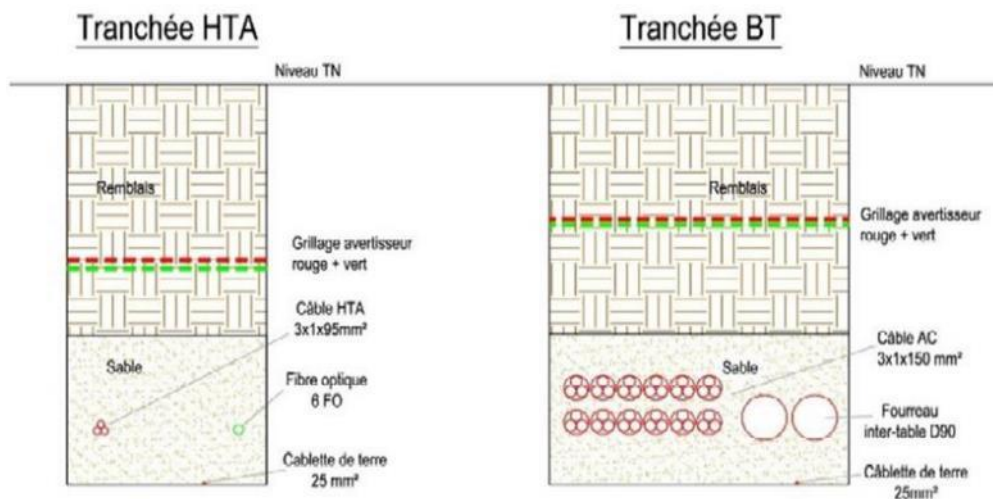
Coupe type d'une tranchée technique HTA/BT (Source : TSE)
